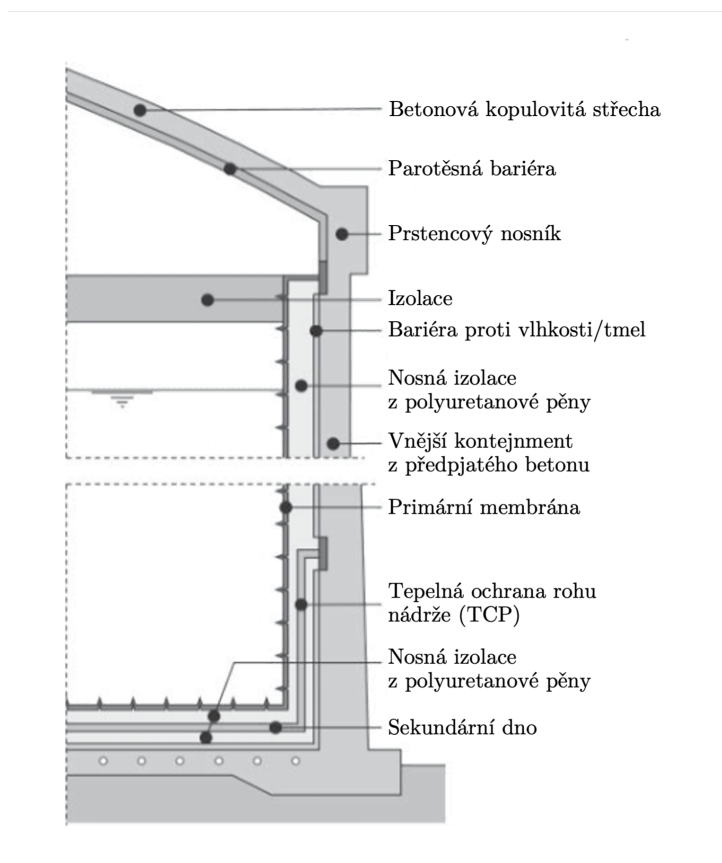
Konstrukce nádrže s plně uzavřeným kontejnmentem [40] (upraveno)
